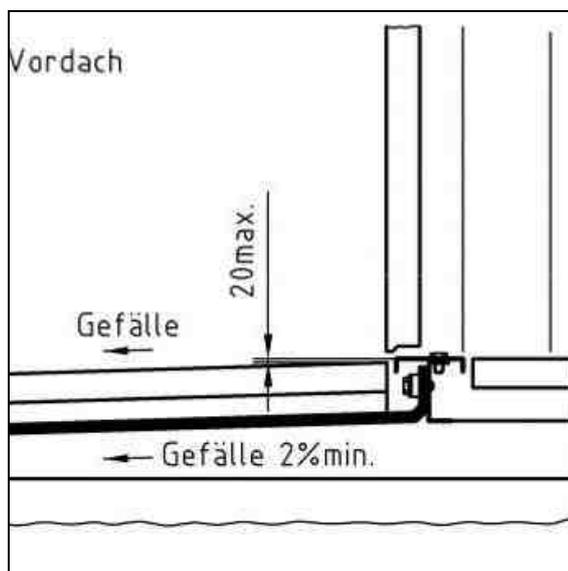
Abschluss an Türschwelle; barrierefrei, nicht drückendes Wasser; hohe Beanspruchung; (Parkdeck, Bahnenabdichtung mit Gussasphalt)
